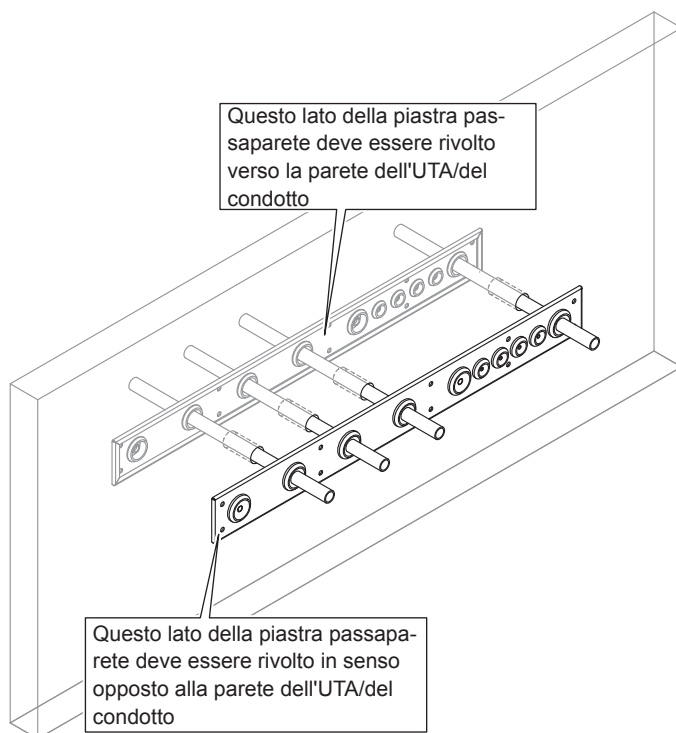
Montaggio della piastra passaparete (installazione esterna)
